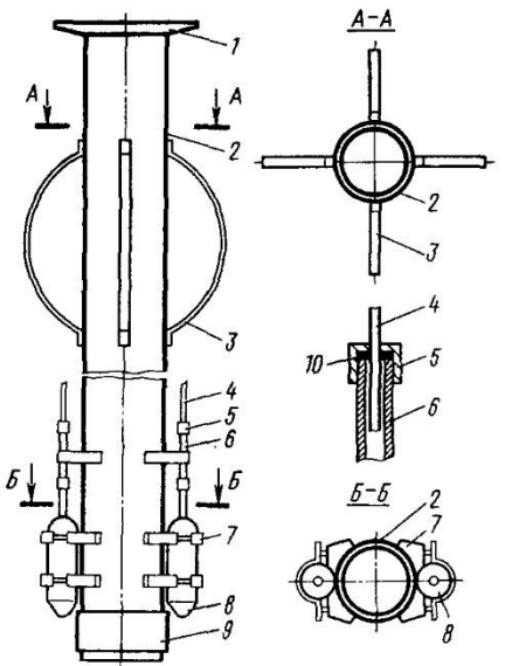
Крепление вибраторов к низу бетонолитной трубы:
